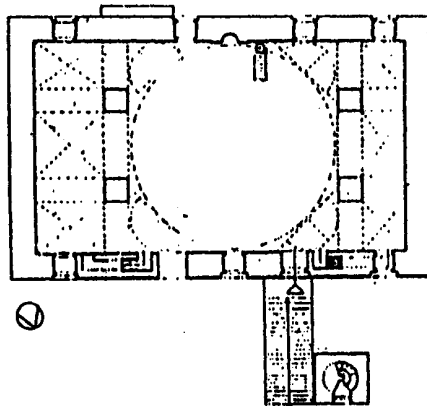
مسقط أفقي لمسجد طلختان بابا قرب مرو
